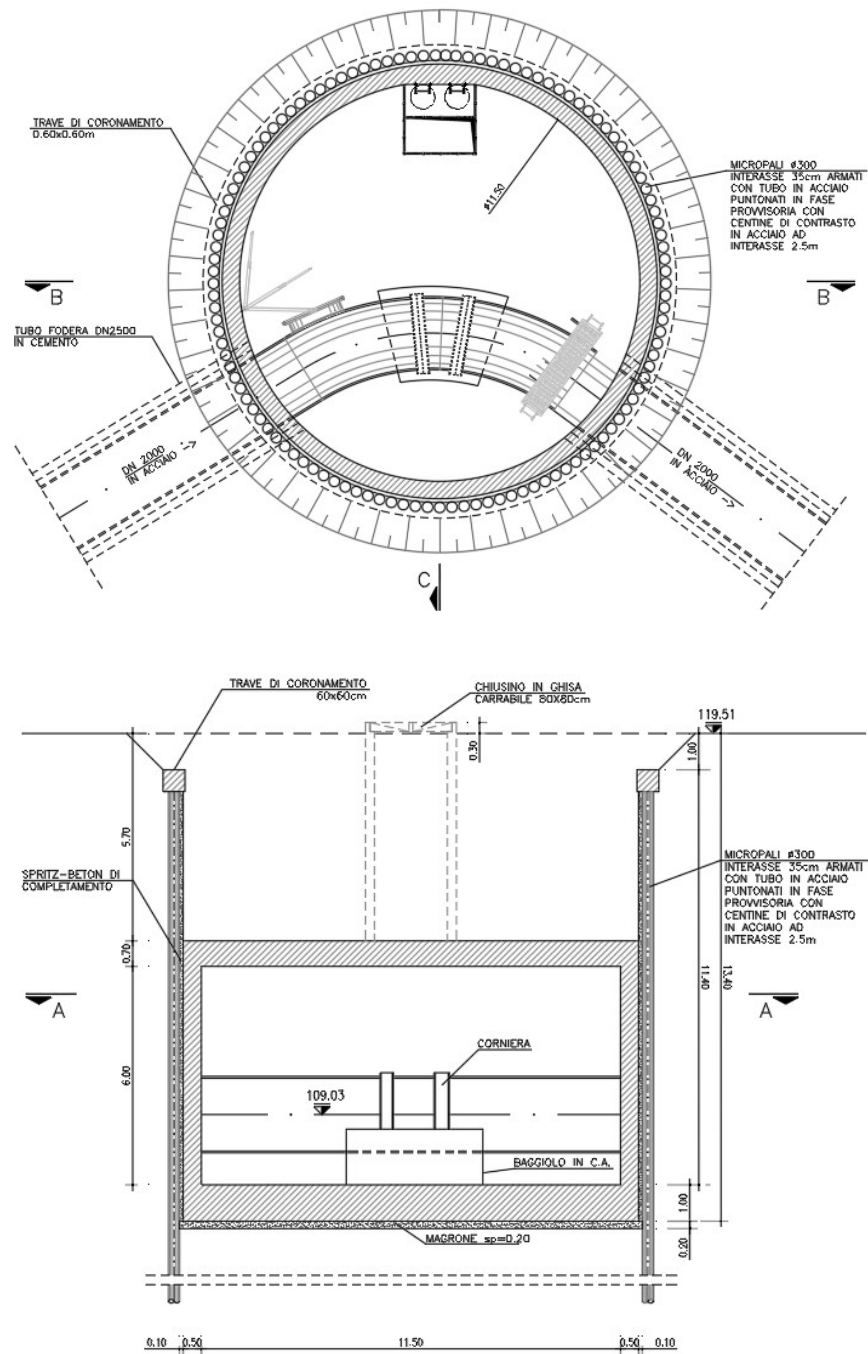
Pianta e sezione del Pozzo Trionfale 1.
